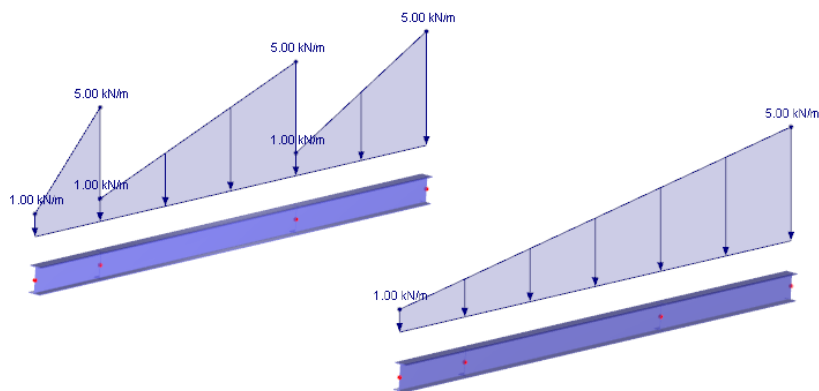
Carga trapezoidal con referencia a las barras (izquierda) y a la lista de barras (derecha)
